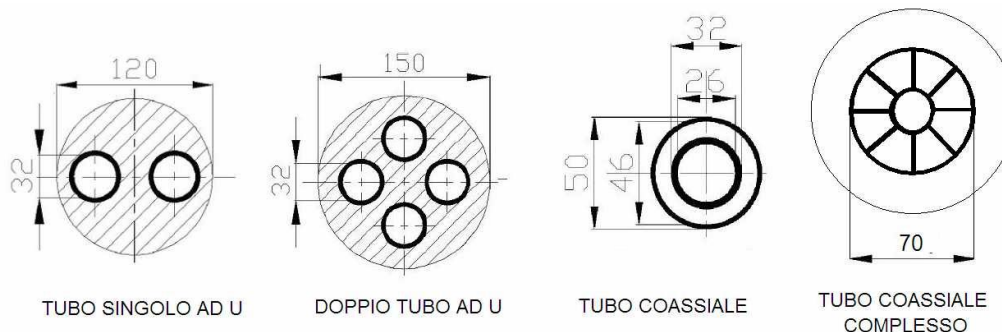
e 2.2.5: Sistema a sonde verticali, dettaglio di una sonda verticale e sua sezione a tipologia a U o coassiale.
